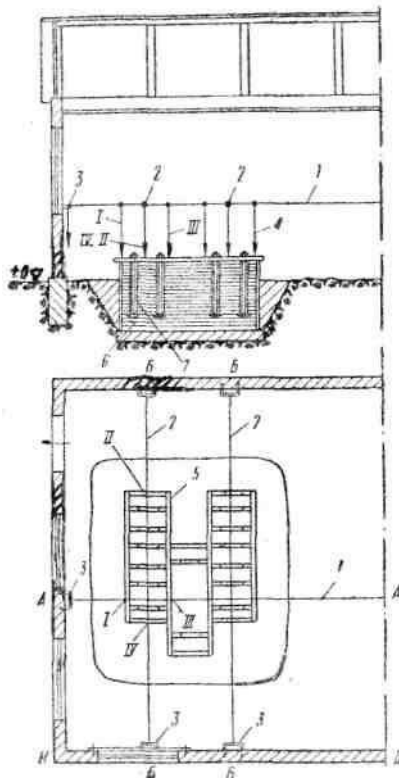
Разметка осей фундамента компрессора в машинном отделении, установка опалубки и шаблона фундамента:
